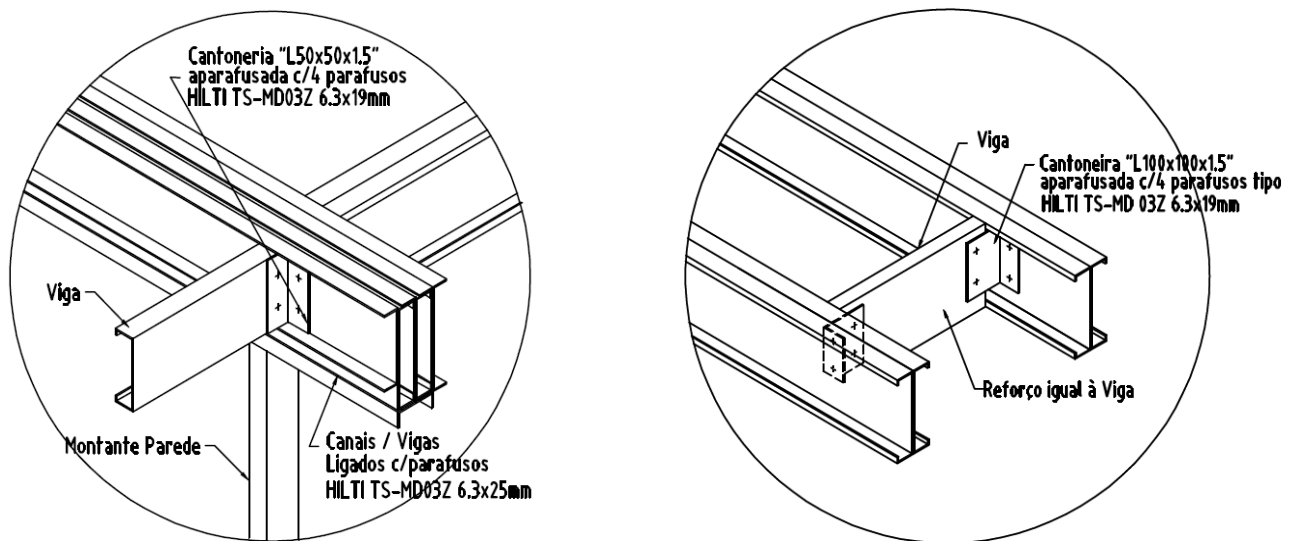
Pormenores de ligação entre perfis de viga com recurso a cantoneiras aparafusadas nos encontros
